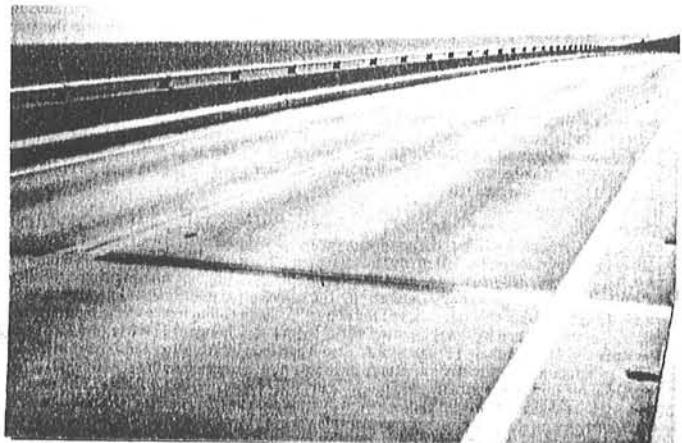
Sebastian Inlet Bridge の普通コンクリートと軽量コンクリートスラブのジョイント部
